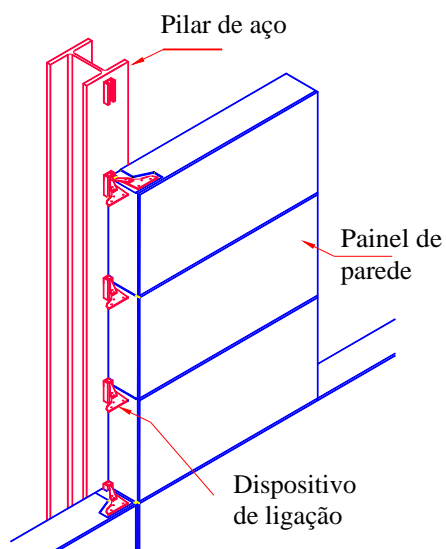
Ligação de painéis horizontais de parede a pilar de aço (fonte: CURRAN, 2003)
